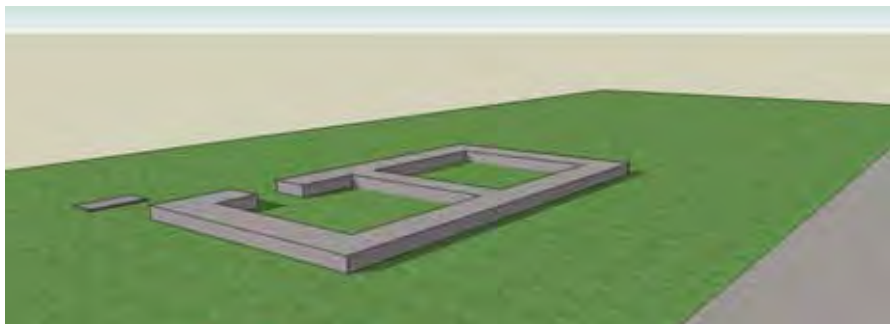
Acondicionamiento del terreno. Fuente: Elaboración propia 2008
